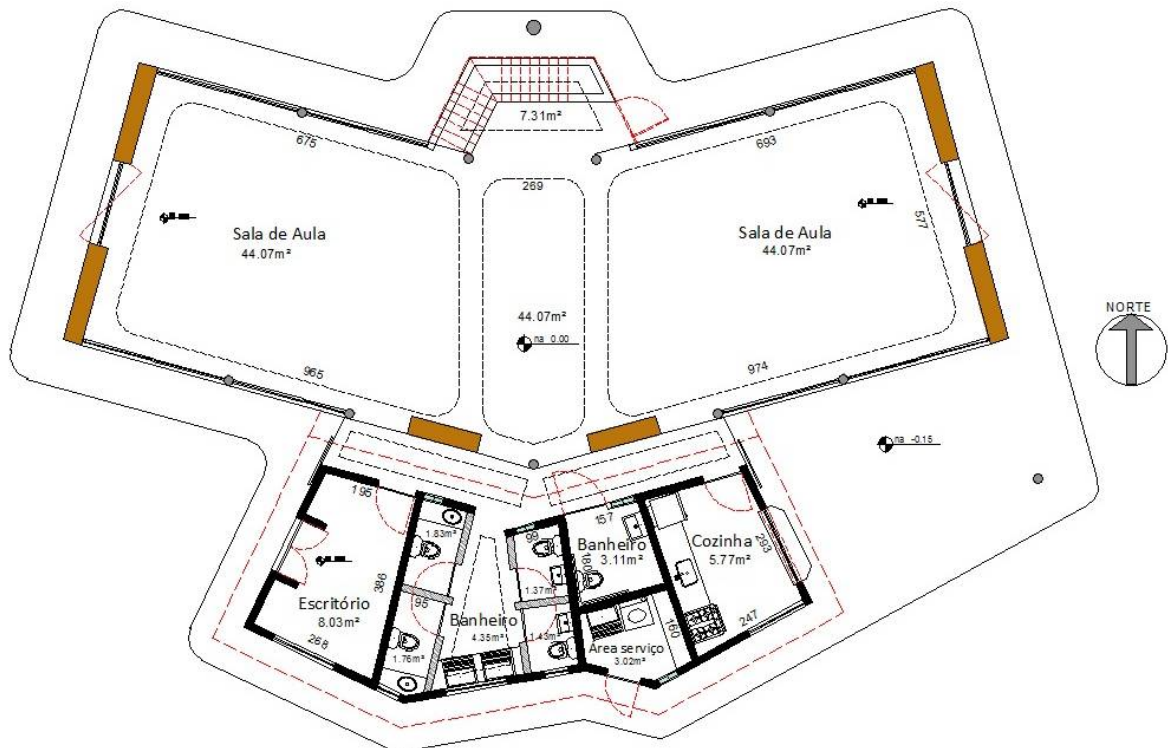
Planta da edificação, sem escala. Fonte: Autores.
